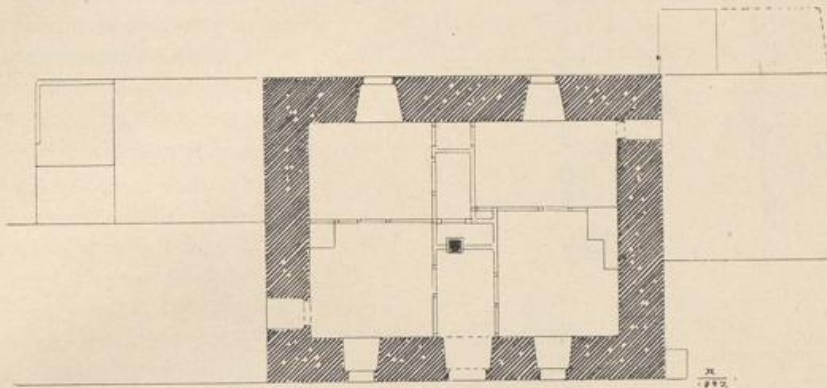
Haus Ober-Sülz. Grundriss des Erdgeschosses.
